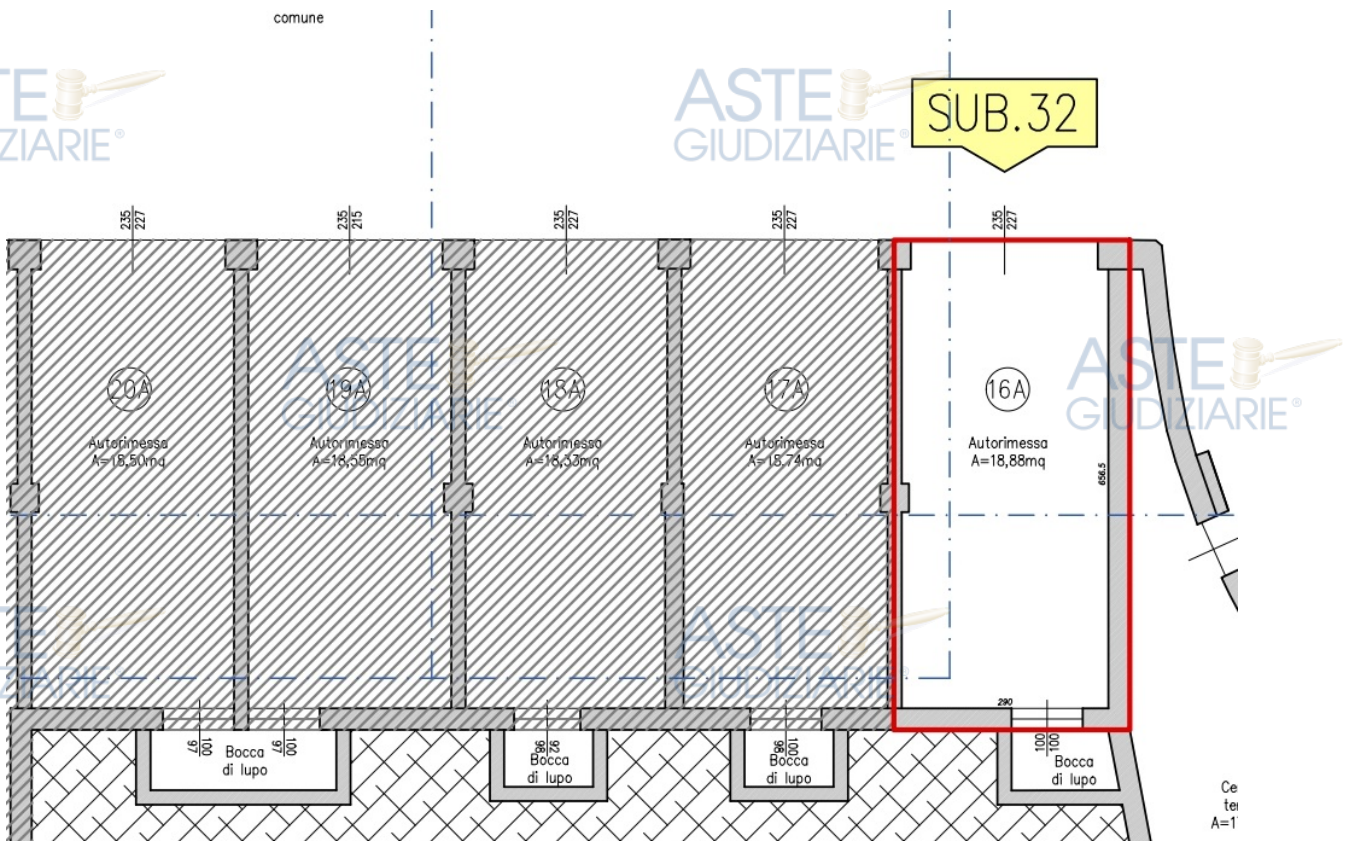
Estratto Tav.A03 S.C.I.A Prot. 15716 del 18.11.2025 – Piano interrato box
